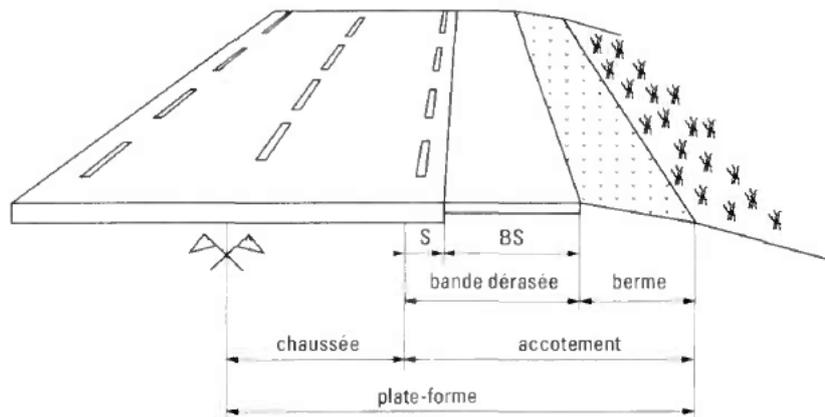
Schéma explicatif du profil en travers type du bord droit subdivision
